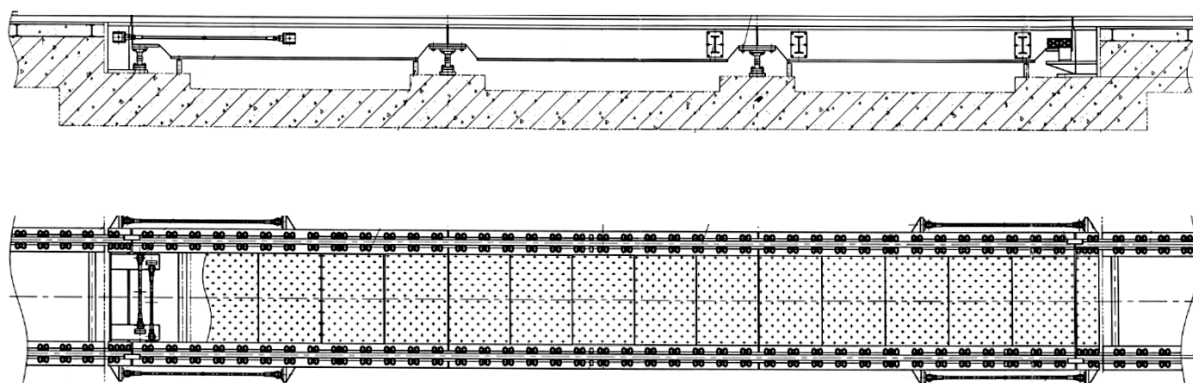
Схема конструкции ГПУ (вид сбоку и вид сверху)
